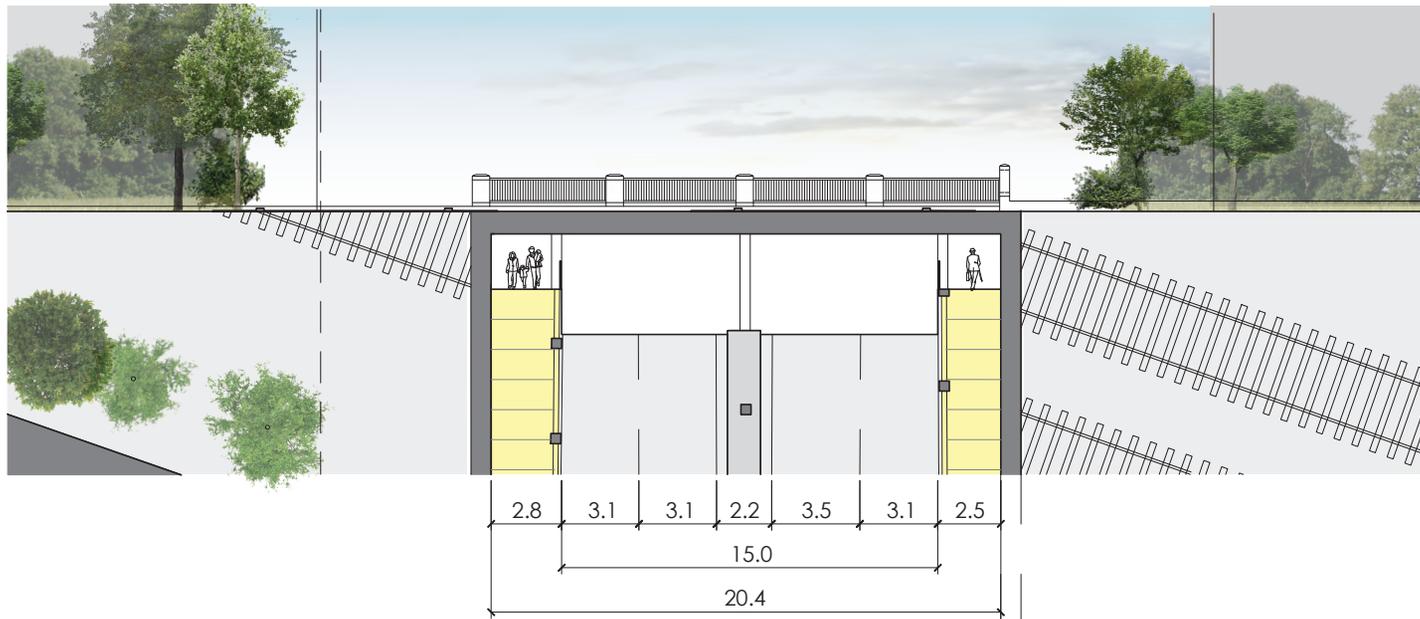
Coupe C2-C2', existant - Av. du Parc, entre avenue Van Horne et rue Beaubien O, échelle 1:300
